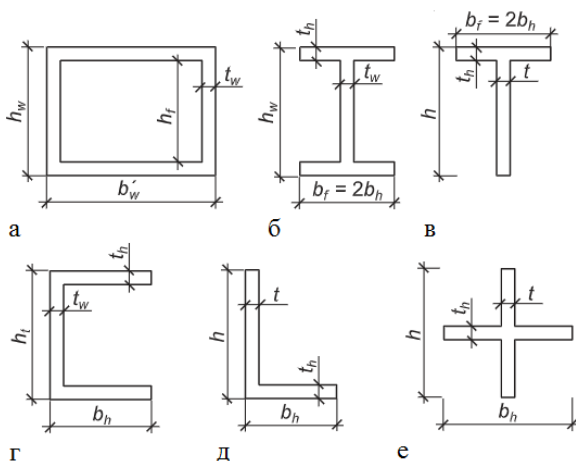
Схемы расчетных сечений элементов, не подкрепленными ребрами жесткости
